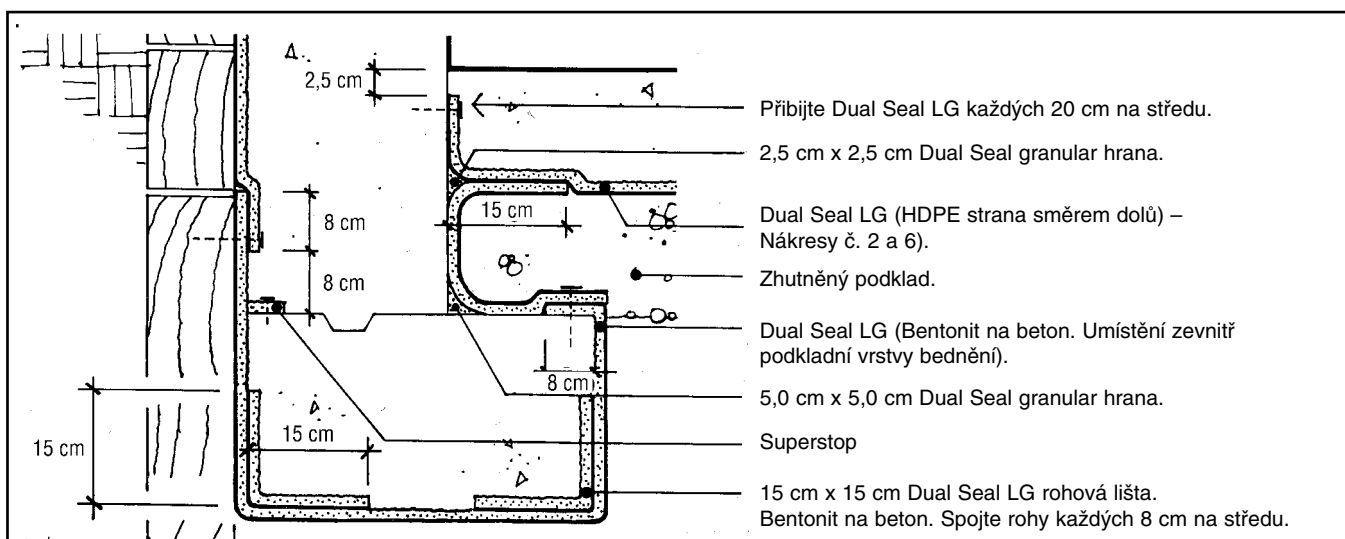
Spojení svislé konstrukce a základové desky/ochranné desky.
